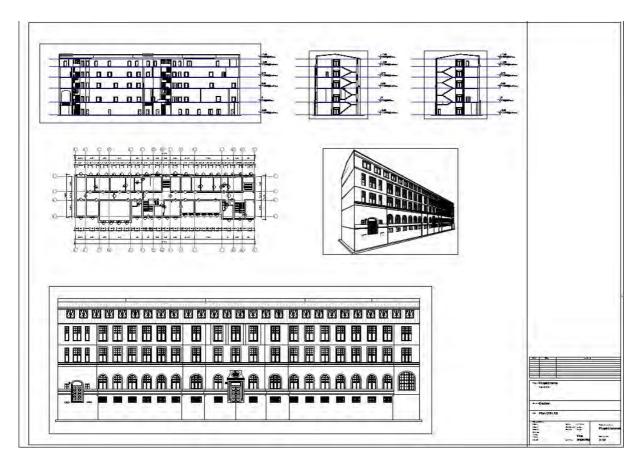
Plan DIN A0 TU München Gebäude IV
